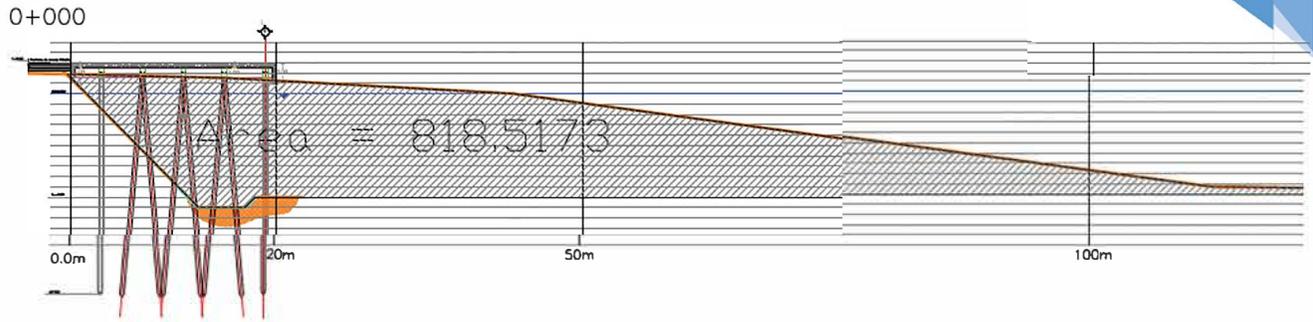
Sección ejemplo al cadenamiento 0+000 para cálculo de volumen de dragado.
